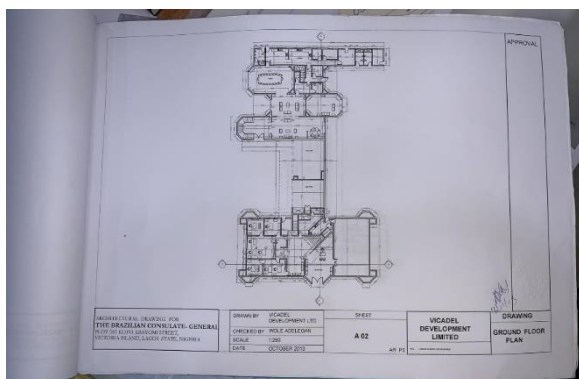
Planta baixa do térreo do projeto. Fonte: Cedido pelo Consulado-Geral em Lagos.
